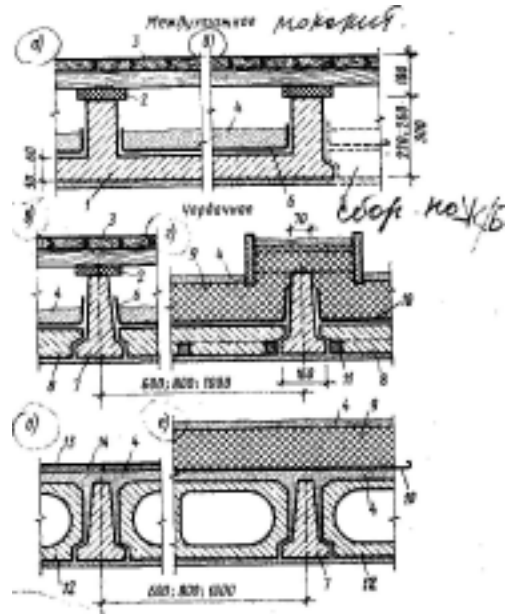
Перекрытия монолитные и сборные по железобетонным балкам:
